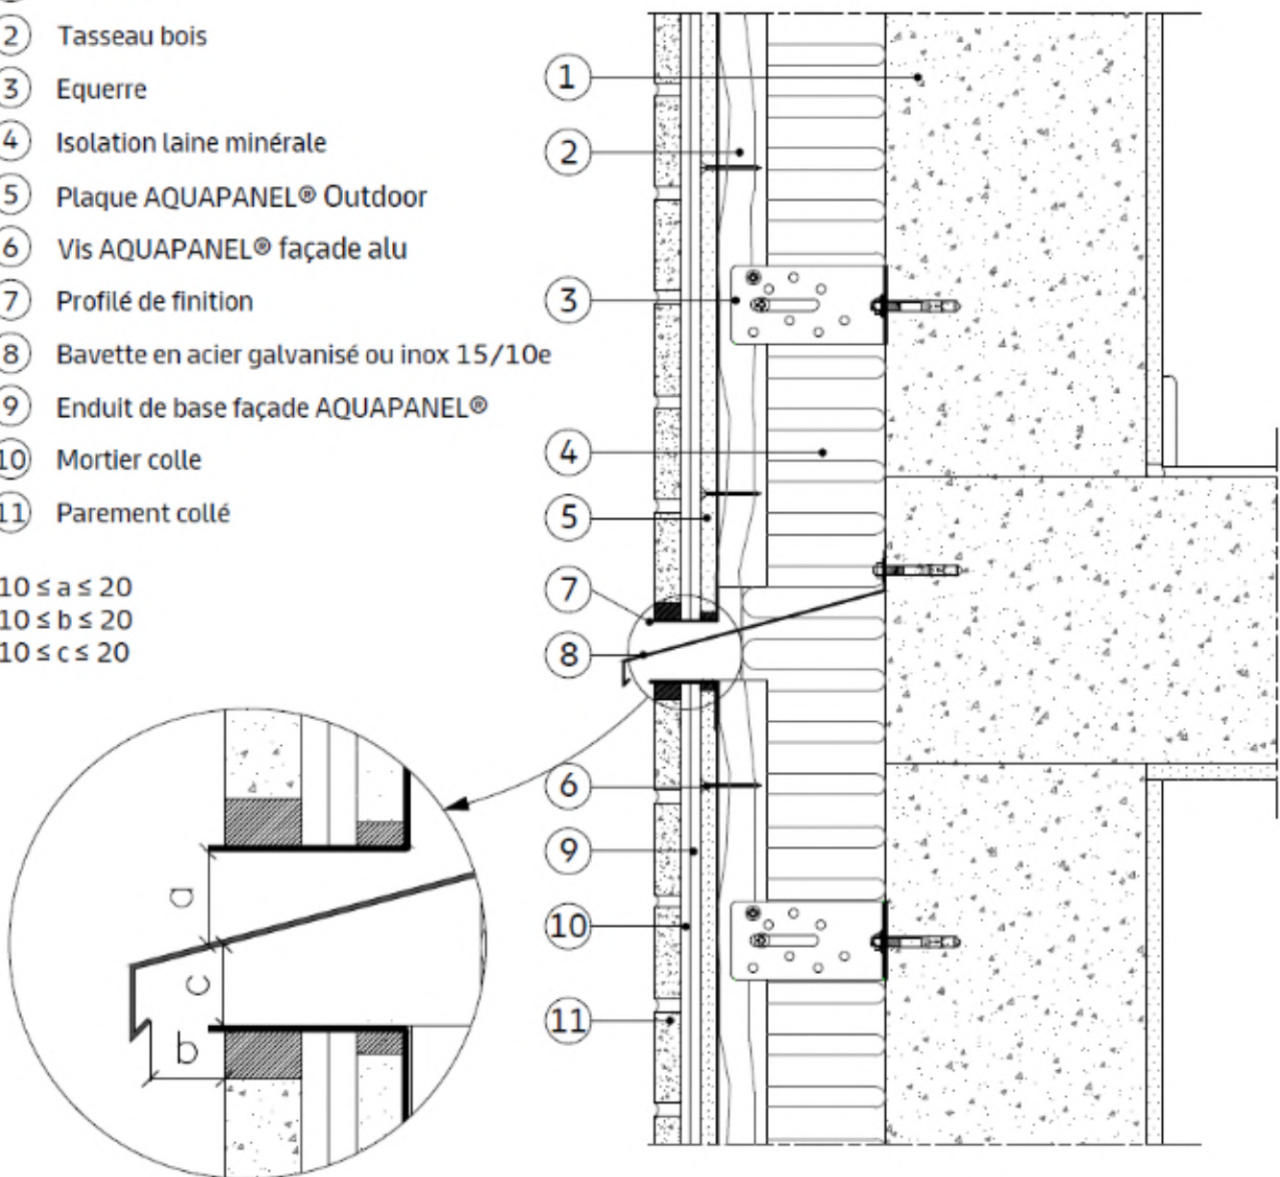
Fractionnement de l'ossature avec bavette au droit de chaque plancher sur béton
